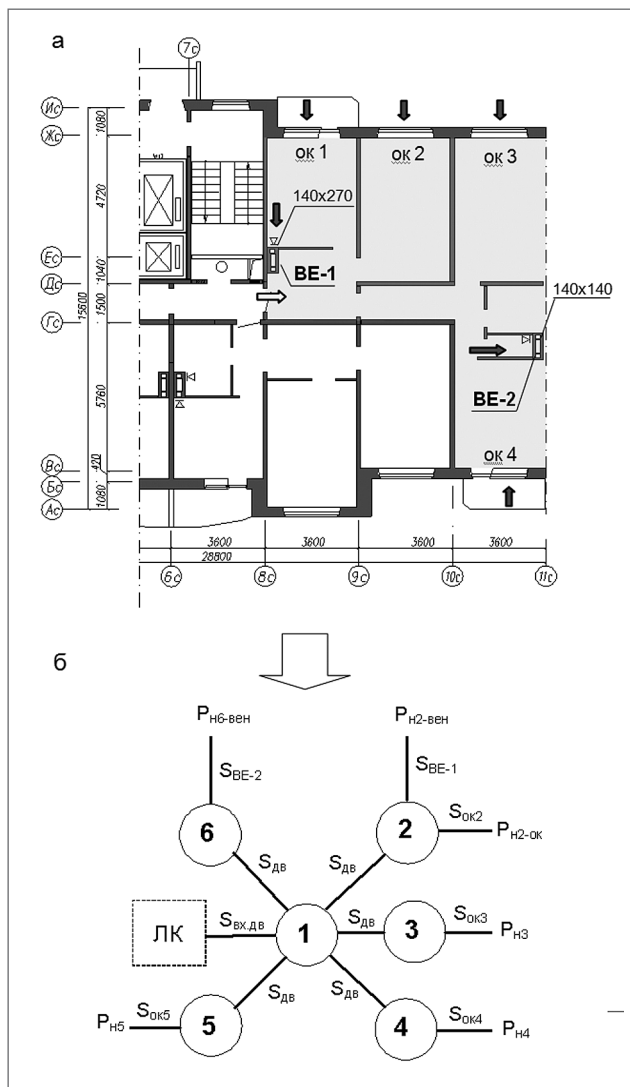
Схематичный план (а) и расчетная схема (б) системы вентиляции трехкомнатной квартиры многоэтажного жилого дома с вертикальными сборными каналами
